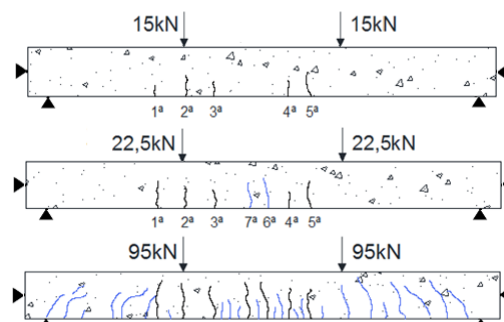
Formação e evolução das fissuras da Viga2old.
